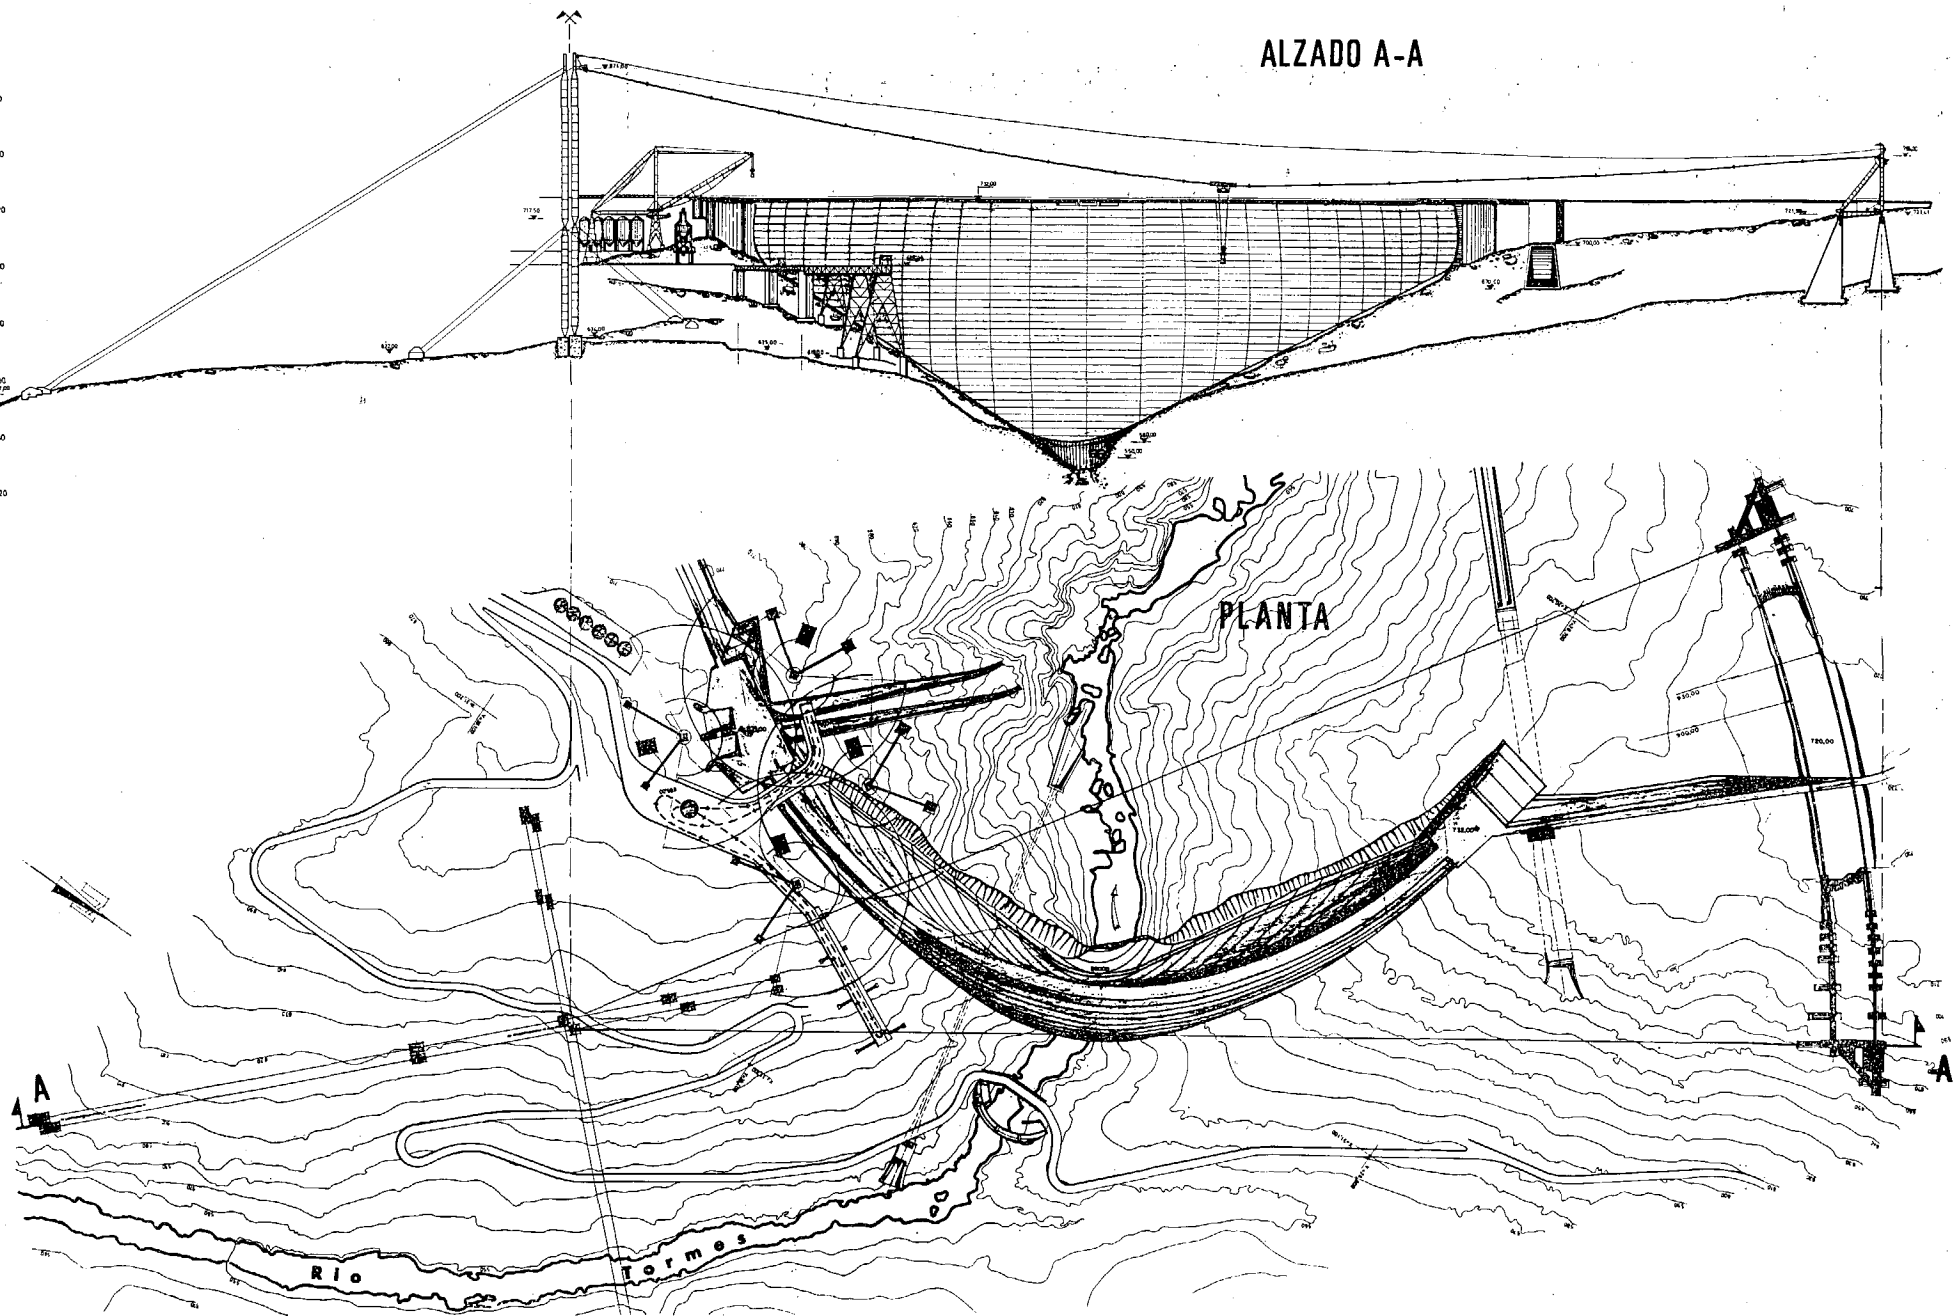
^a — Presa de Almendra, de IBERDUERO, S. A. Alzado y planta de las instalaciones de puesta en obra del hormigón en la bóveda y estribos.
